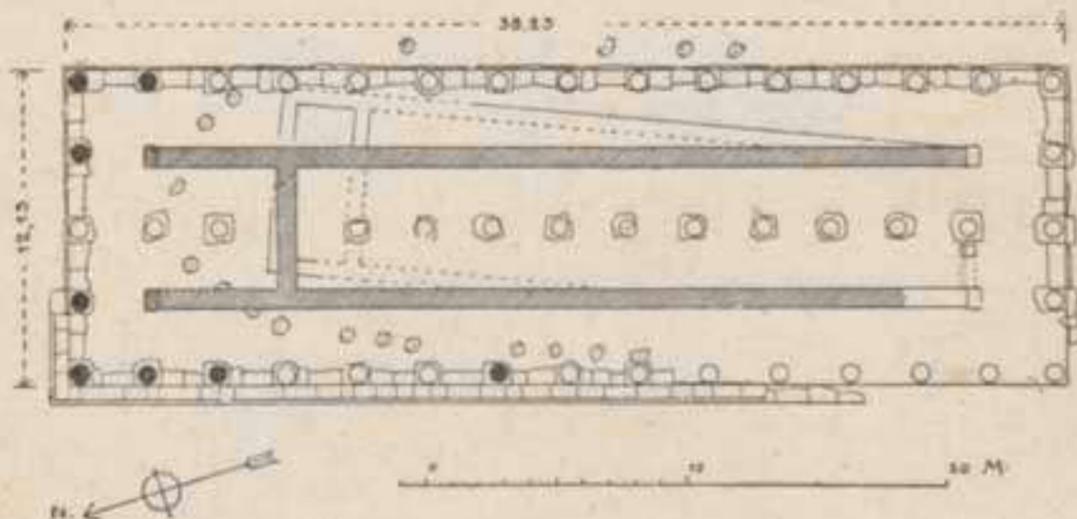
Planta del templo de Thermon, en Etolia (5 × 15 columnas: nave central, 12 columnas)
